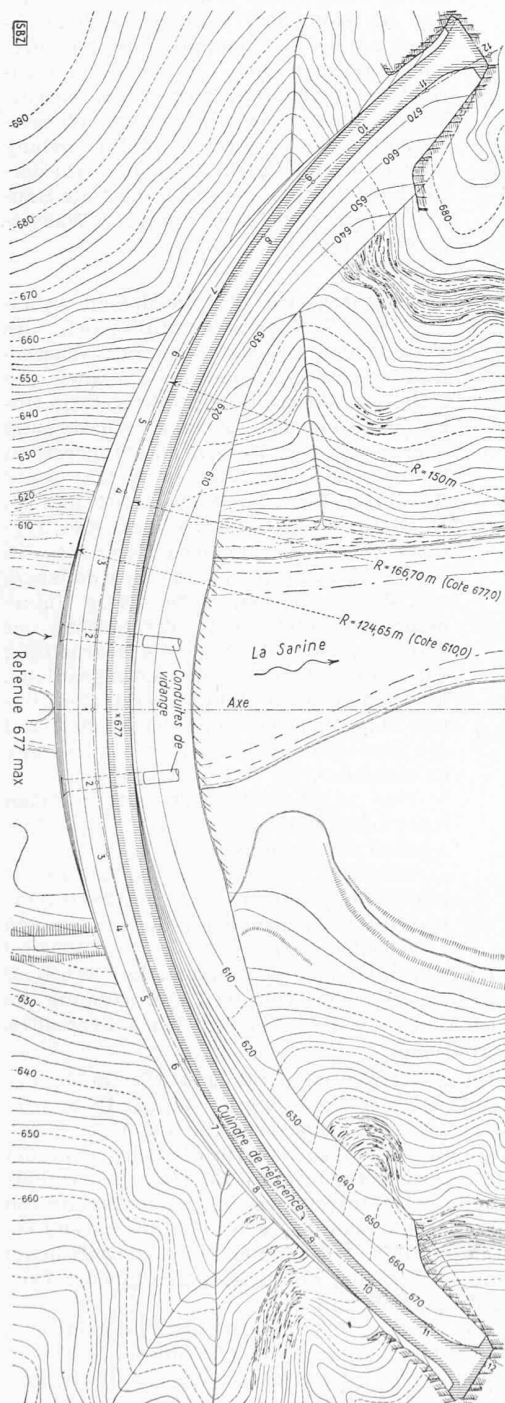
Grundriss 1:1500 (Horizontalschnitt Kote 677 anschrafft)
